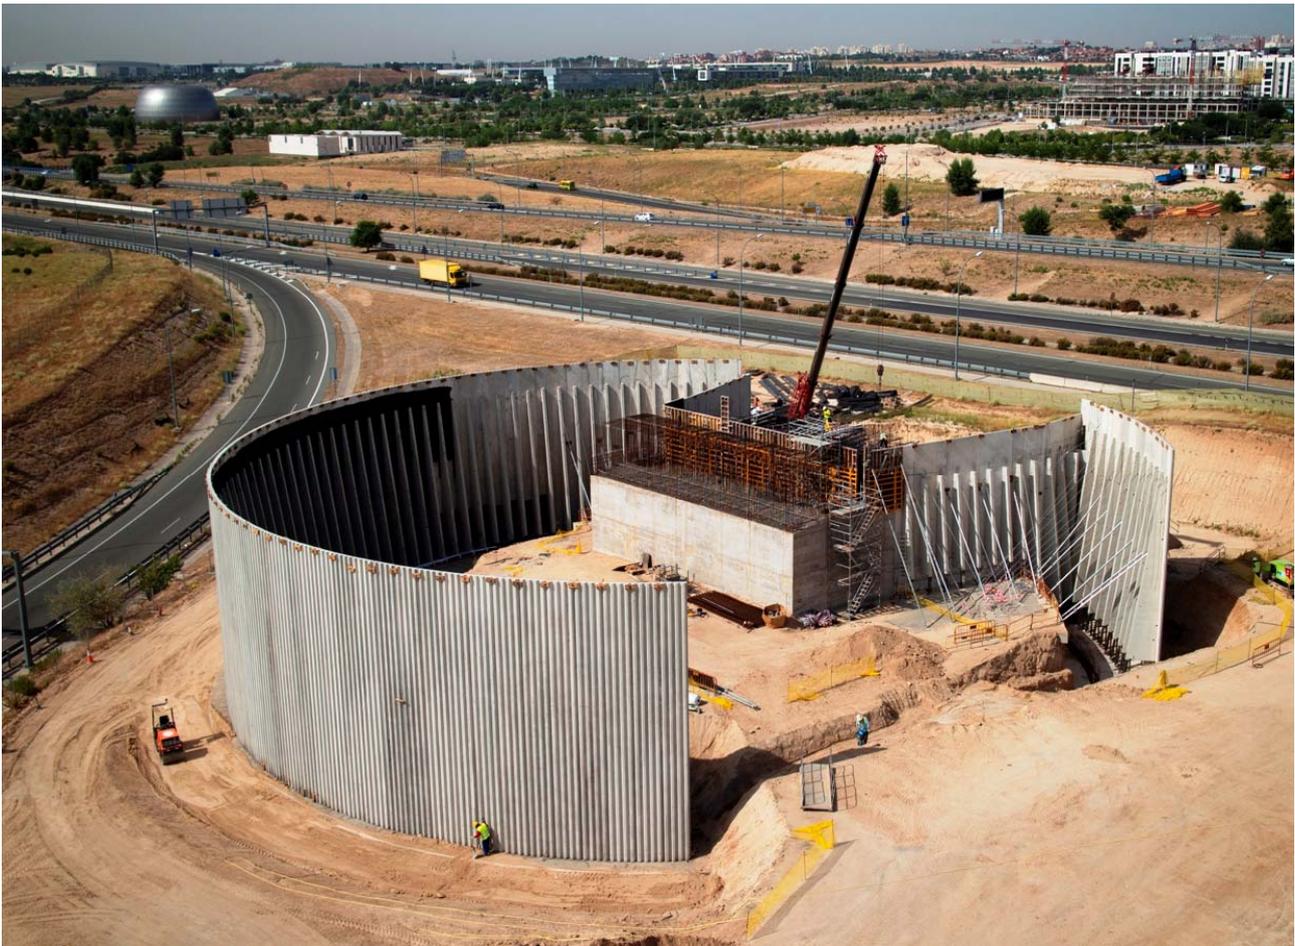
Vista del E-2 tras el montaje de los muros de glorieta y falso estribo
